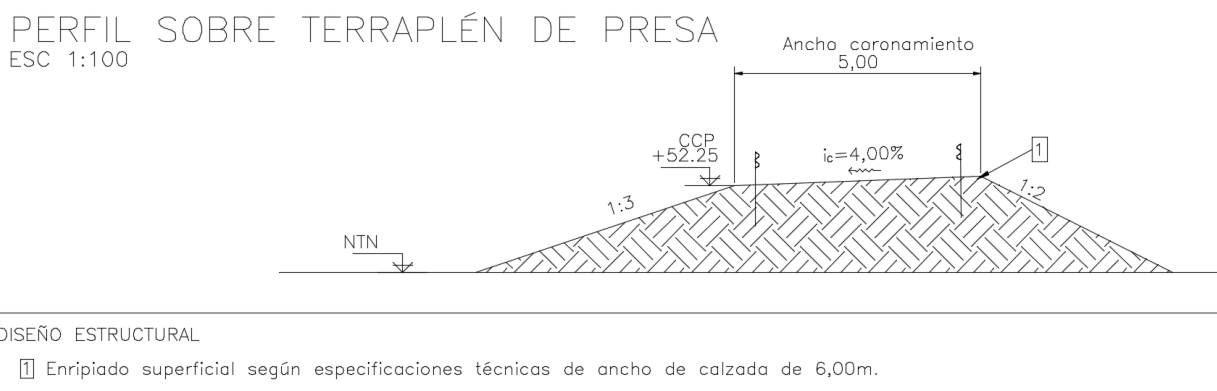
Perfil transversal tipo del terraplén de presa. Fuente: Elaboración propia.
